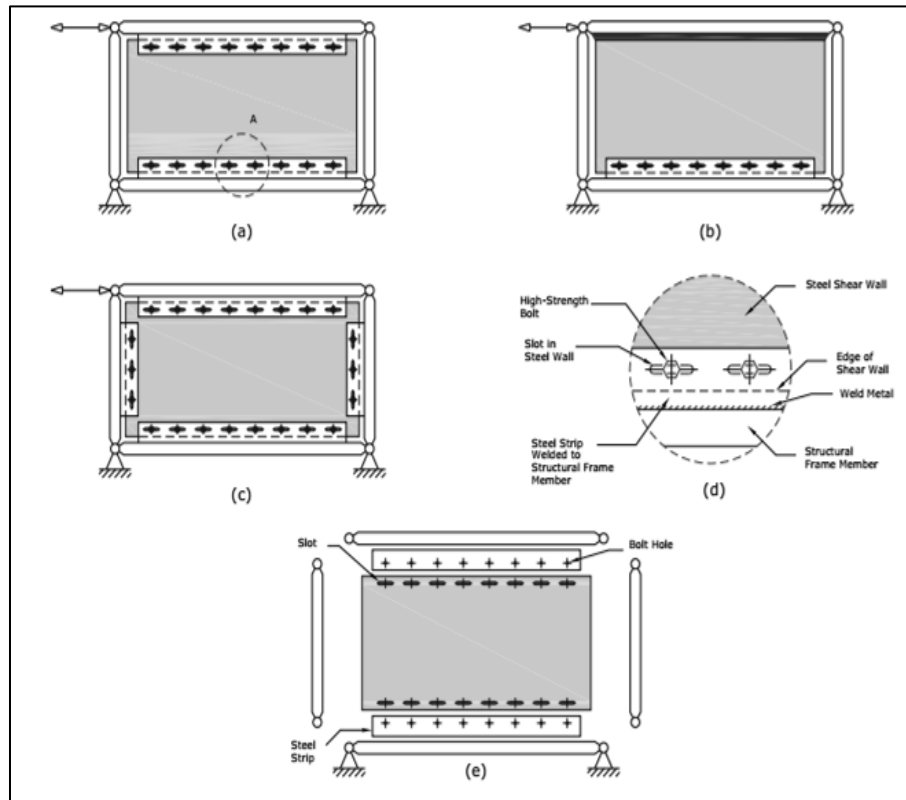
Sistemas alternativos que se utilizan para estabilizar un pórtico típico de (SSWAF)
